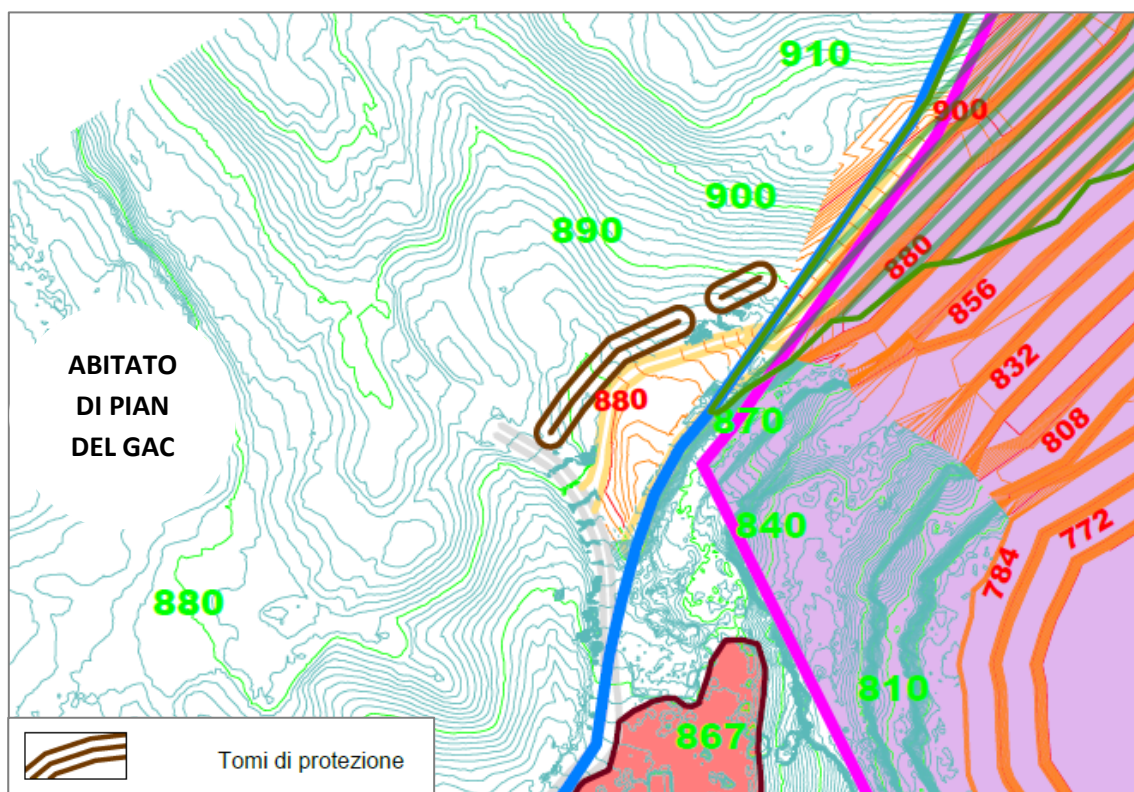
Profilo di progetto del tomo previsto a protezione di Pian del Gac – Estratto Tav. B di progetto
